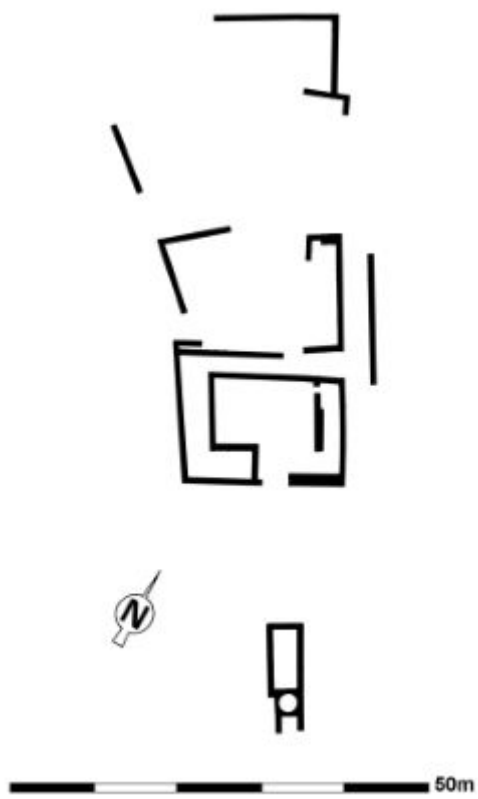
Planta muraria del cortijo Nuevo, zona republicana. Fidel Baena.
